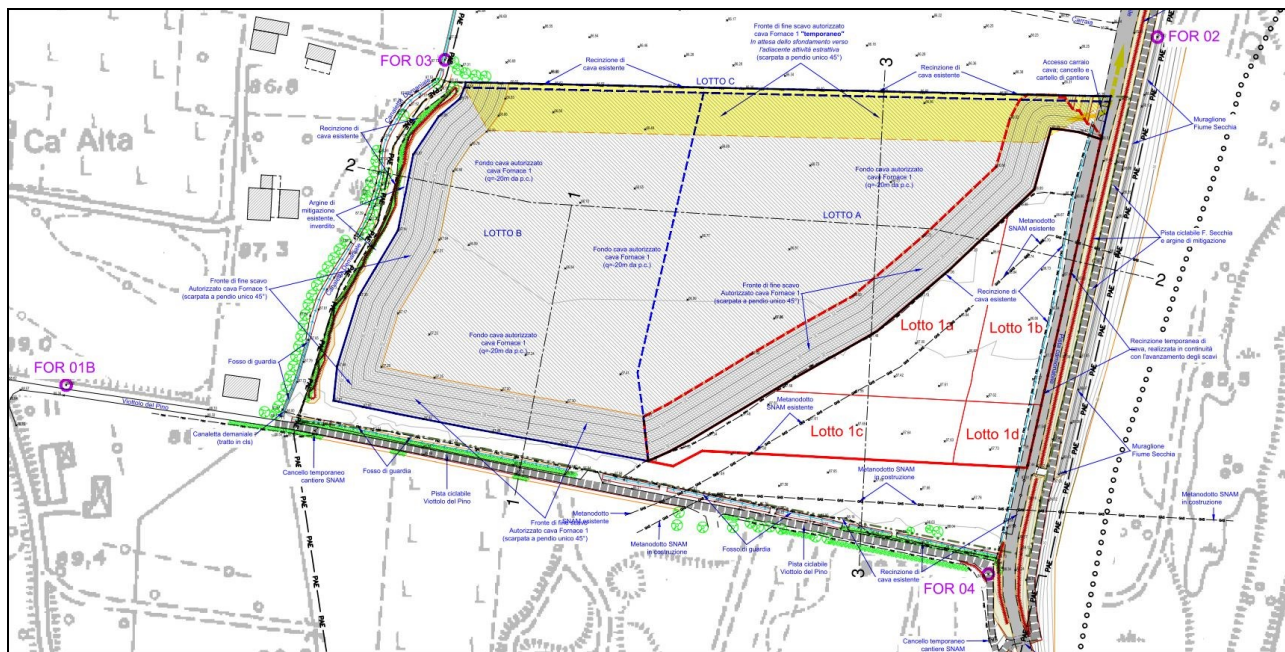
Stralcio Tav. 02 – Stato di Fatto "Planimetria dello stato Autorizzato - Fine scavo cava Fornace 1".
